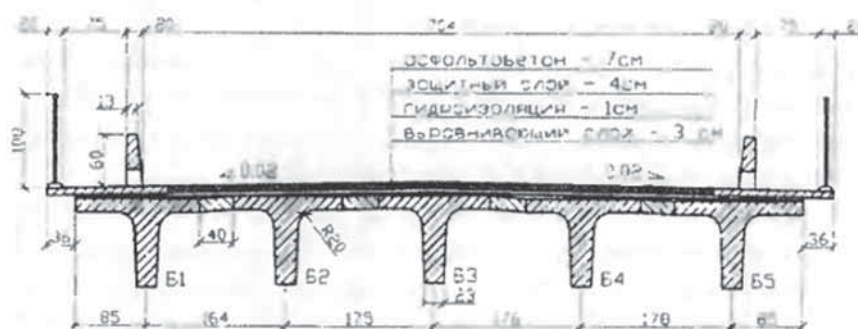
Поперечное сечение пролетного строения со стеклопластбетонными балками [12]
